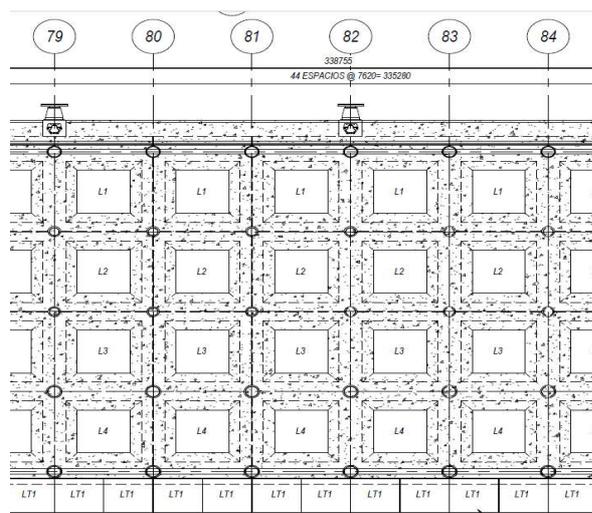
Planta Típica de módulos de losas y vigas prefabricadas (L4, L3, L2 y L1)
